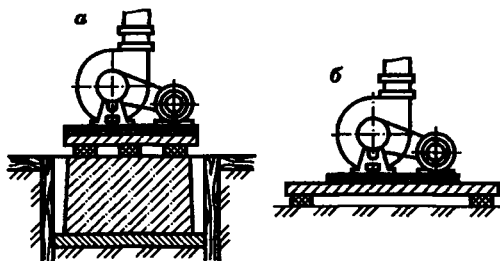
Установка агрегатов на виброгасящем основании: *а* — на фундаменте и грунте; *б* — на перекрытии
